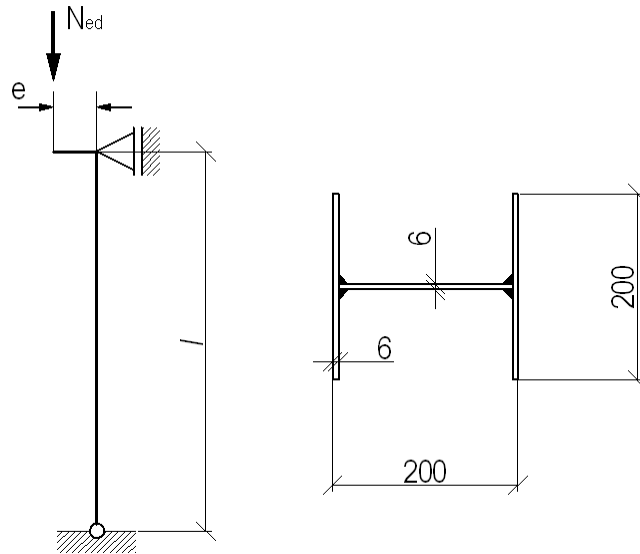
Расчетная схема колонны и схема ее поперечного сечения
